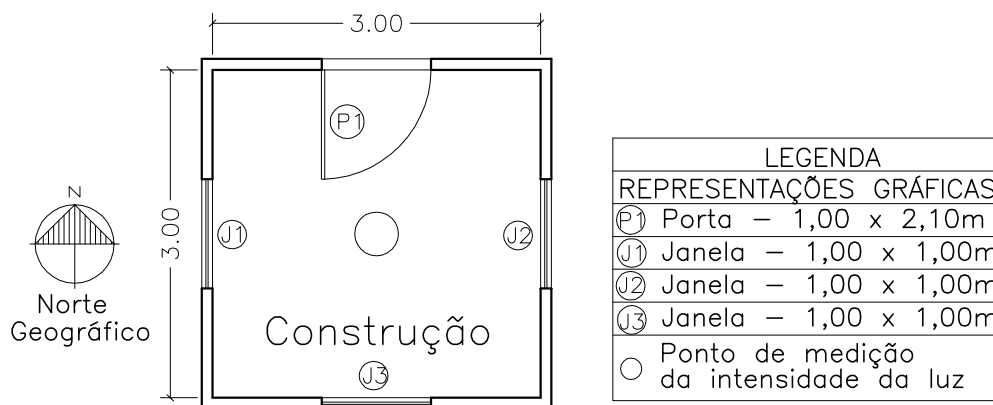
Casa Original – Estudo de Caso 1 – Planta Baixa
